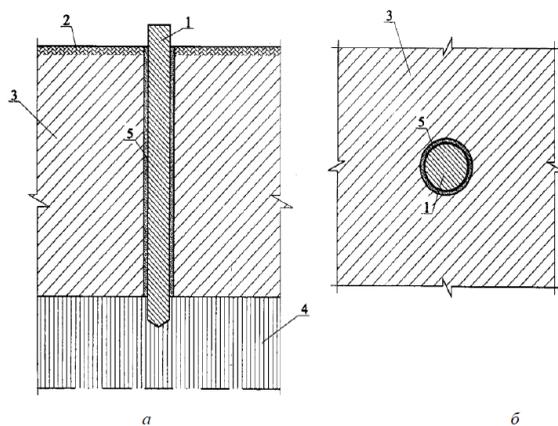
Свайный фундамент с антифрикционным покрытием (эластичной оболочкой): а – продольный разрез; б – поперечный разрез; 1 – свая; 2 – поверхность просадочного грунта; 3 – просадочная толща; 4 – непросадочный грунт; 5 – антифрикционное покрытие (эластичная оболочка).
